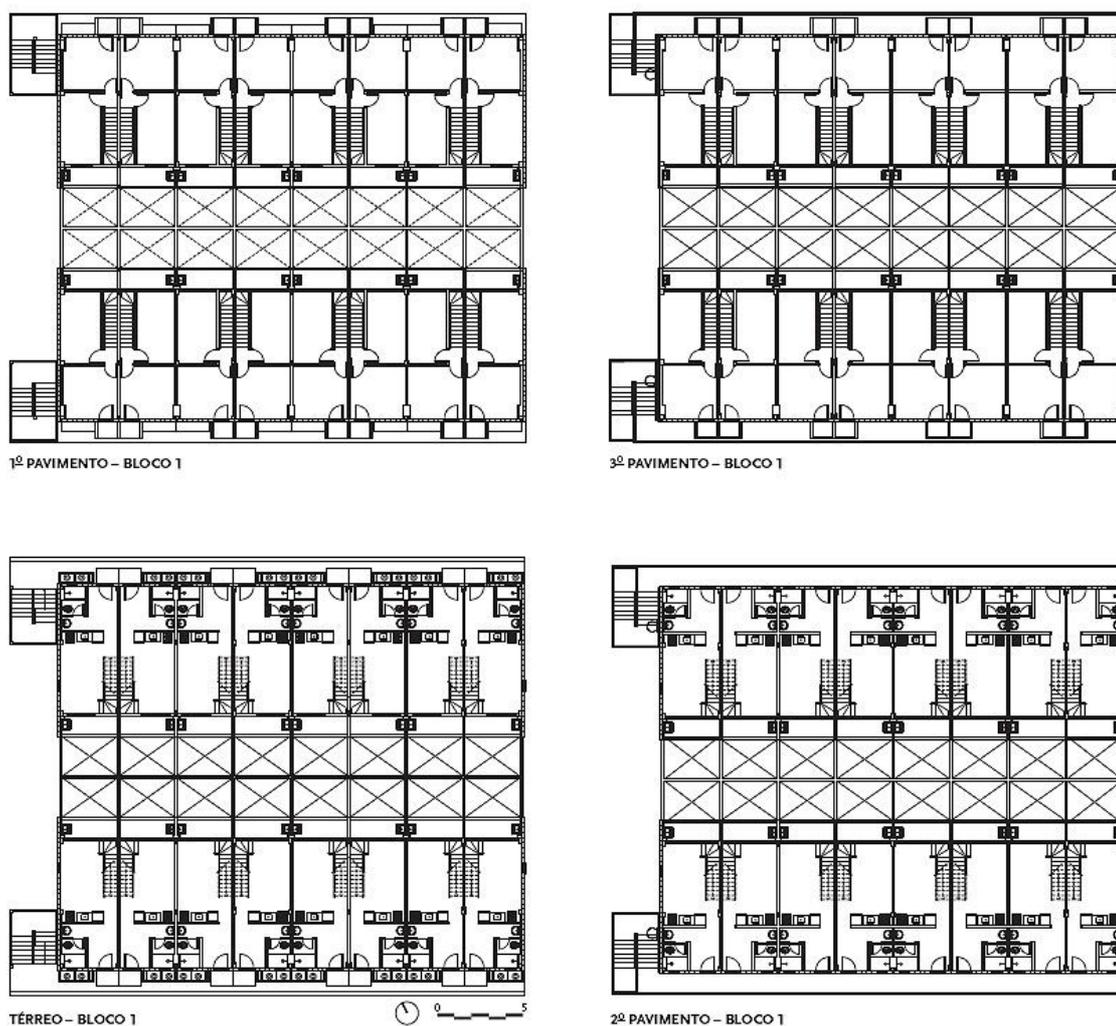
Plantas dos pavimentos do Residencial Itaca.
